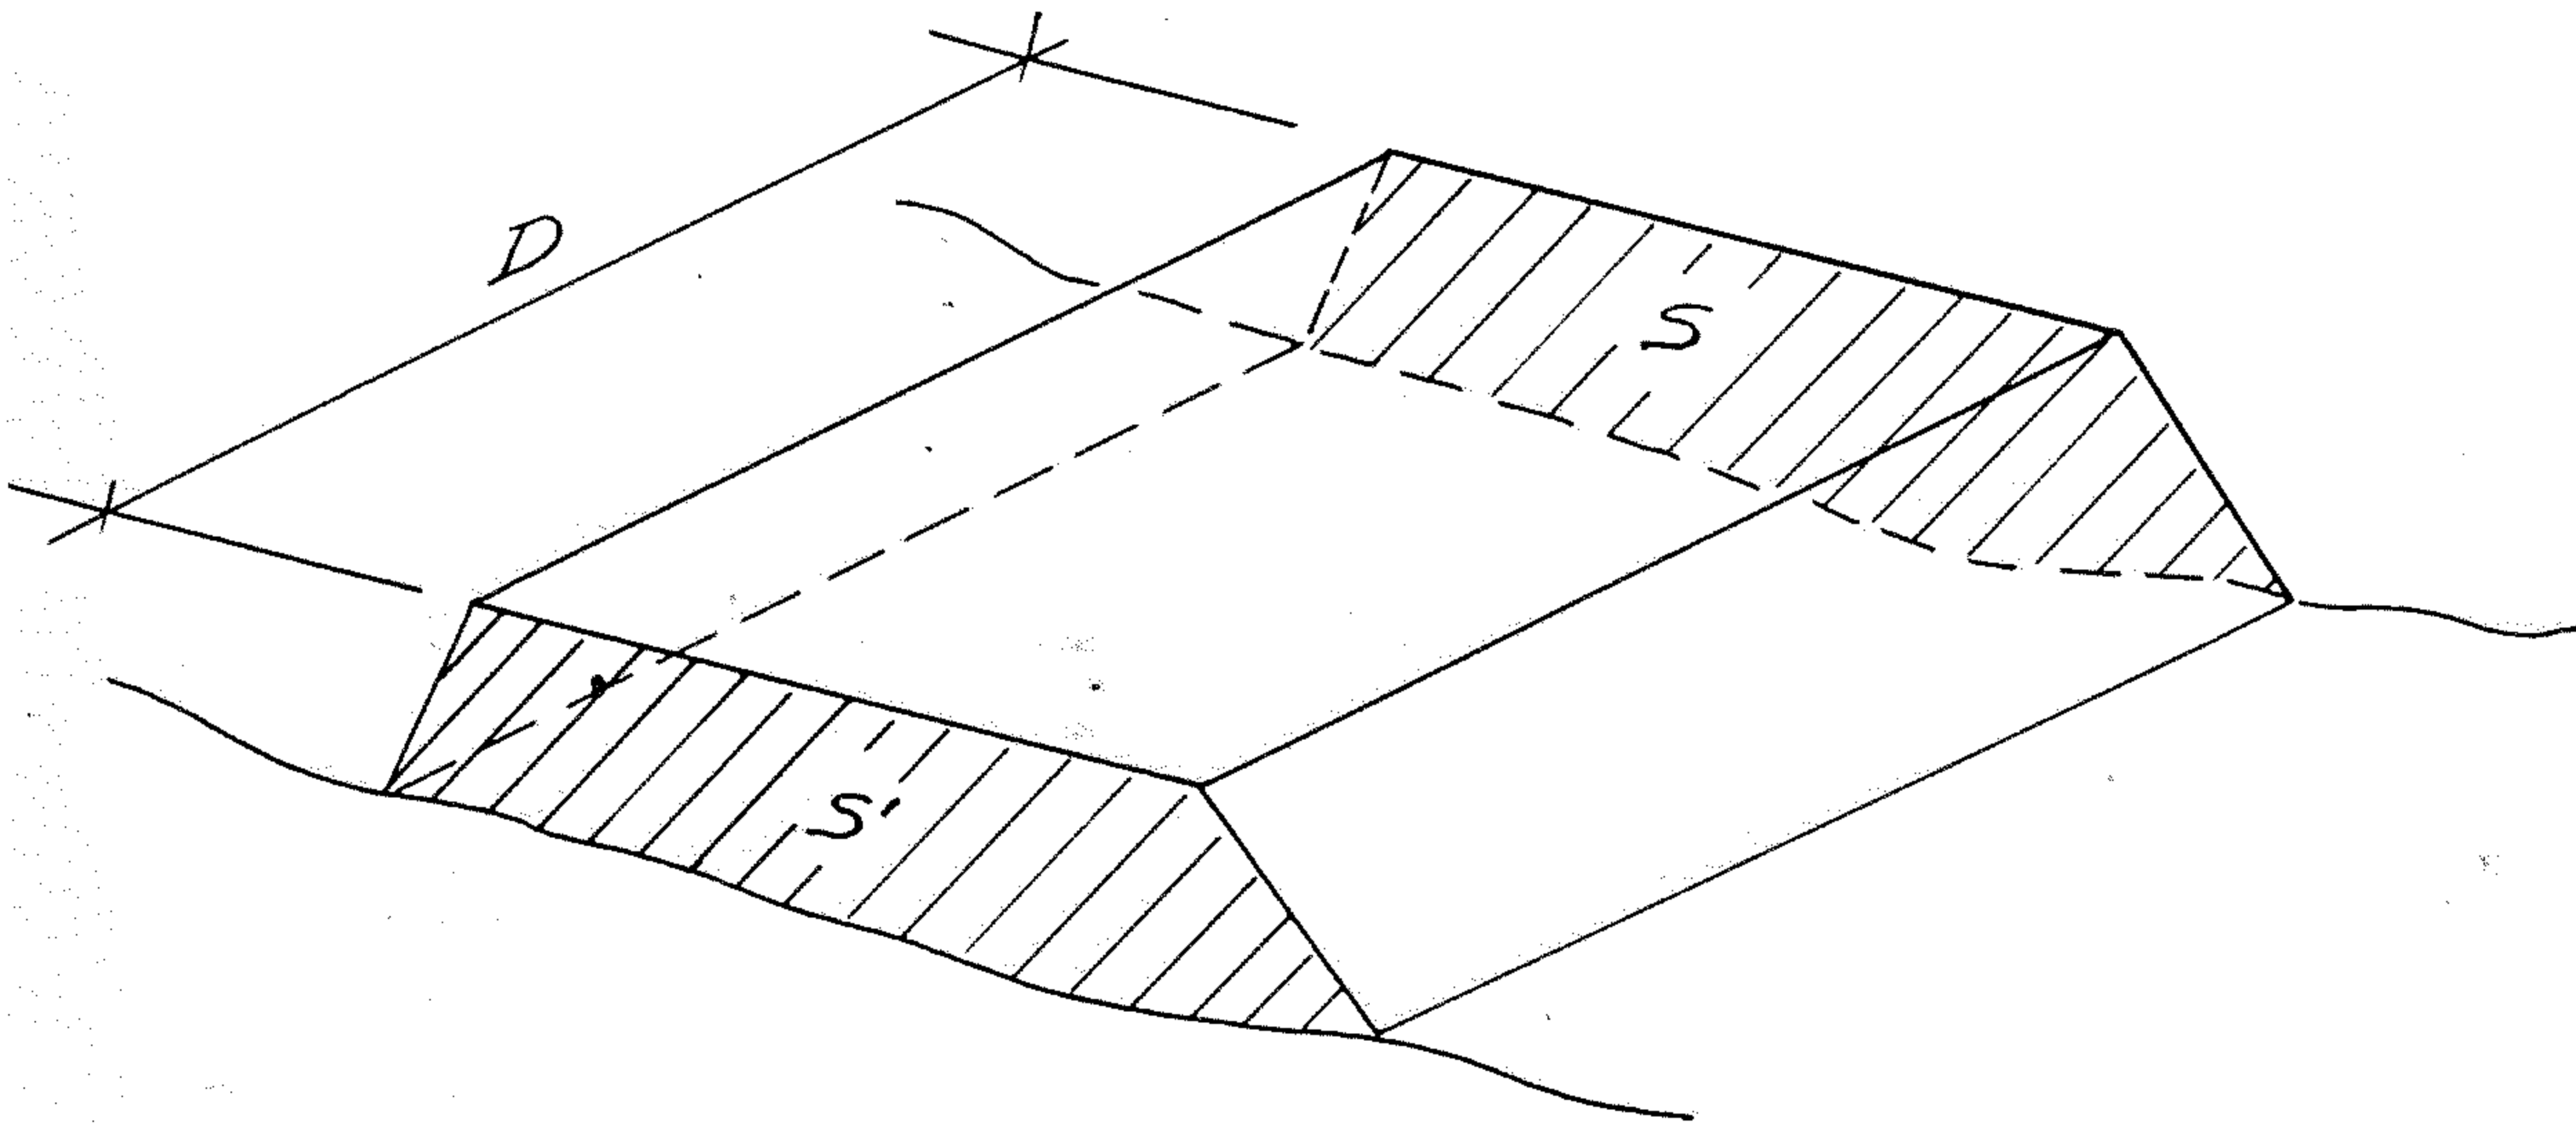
DOS SECCIONES EN CORTE O DOS SECCIONES EN RELLENO
